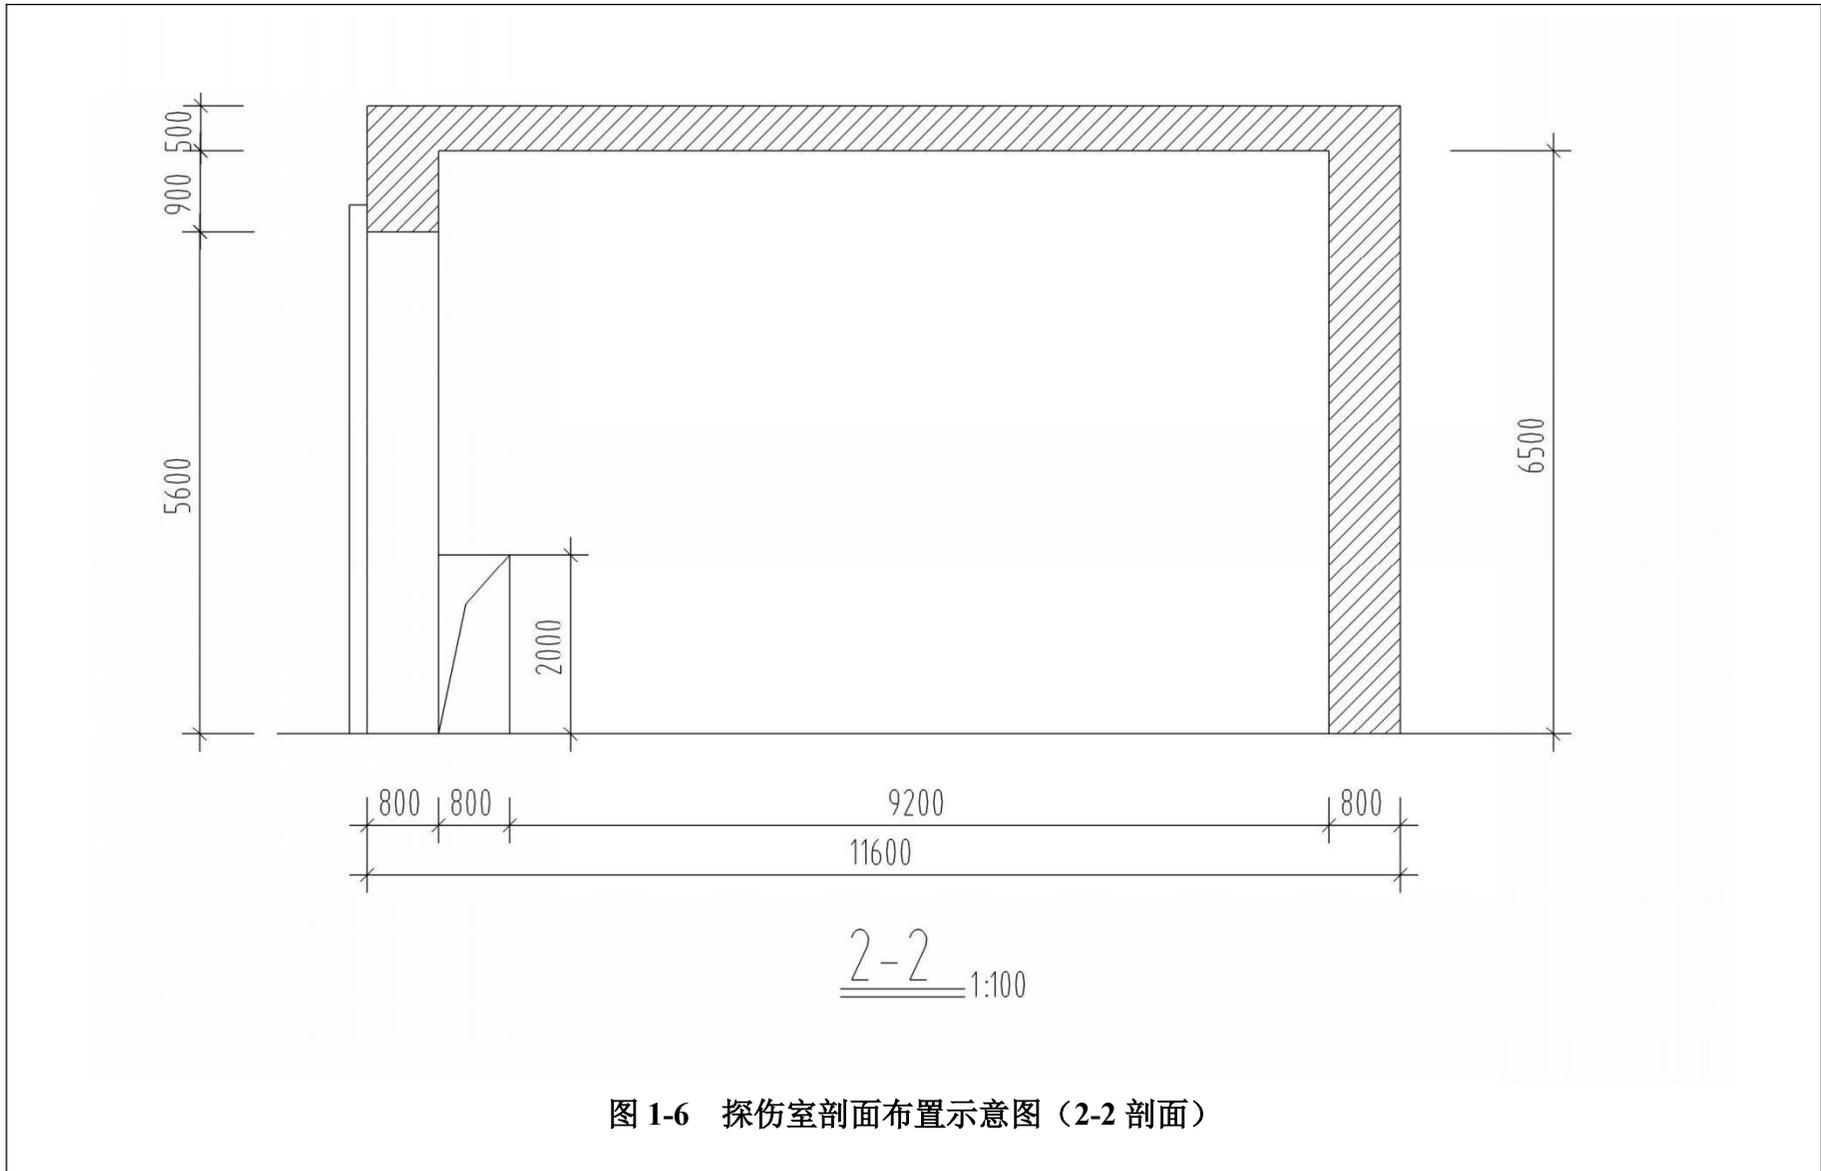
探伤室剖面布置示意图 (2-2 剖面)
